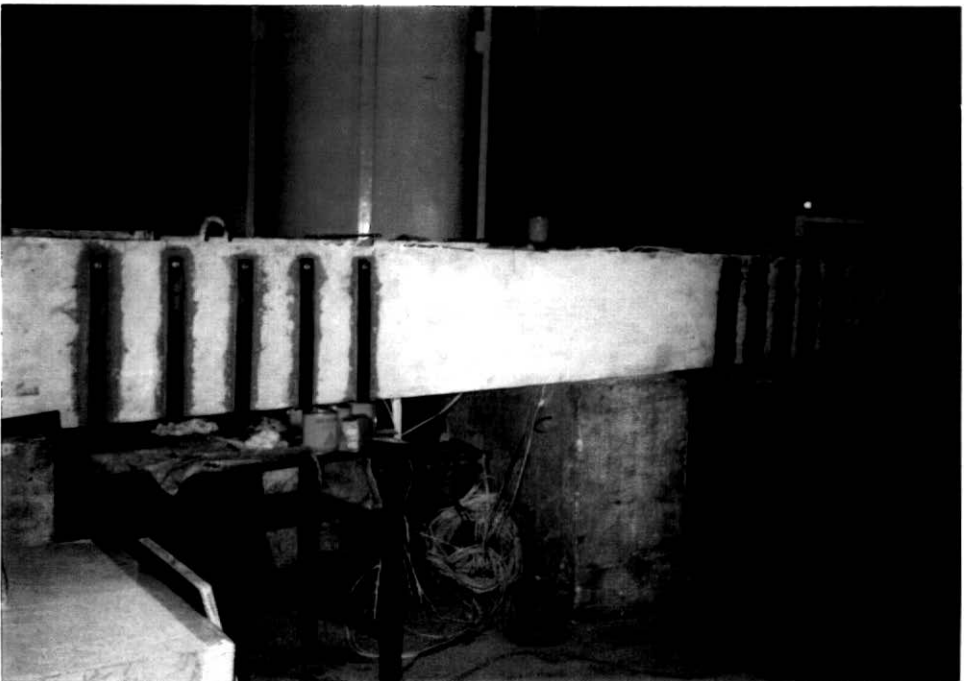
Viga V5 após o reforço executado com a viga descarregada
